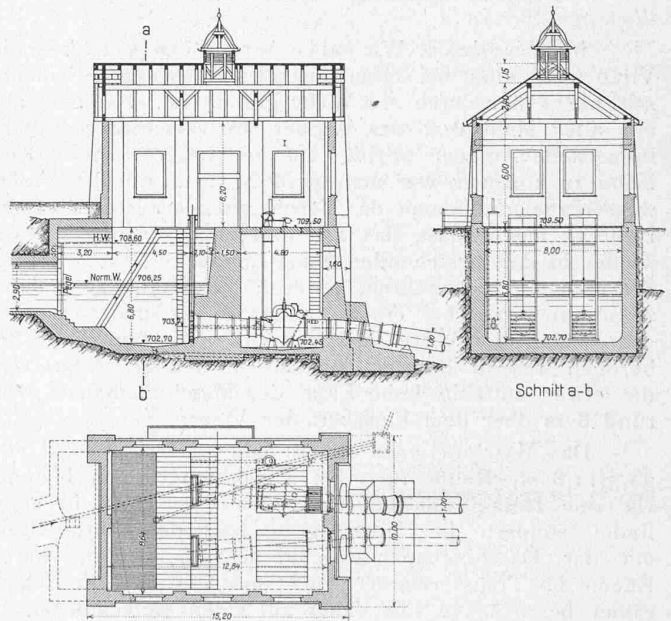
Das Wasserschloss; Grundriss und Schnitte 1: 400.
